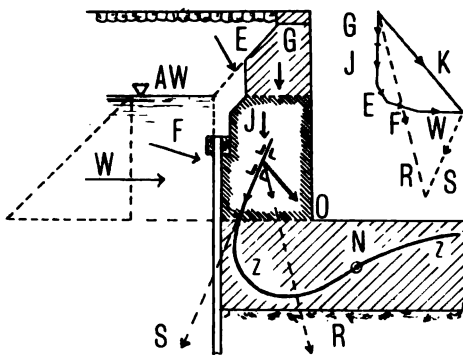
Eiseneinlage bei vorhandenem Einspannmomente.
